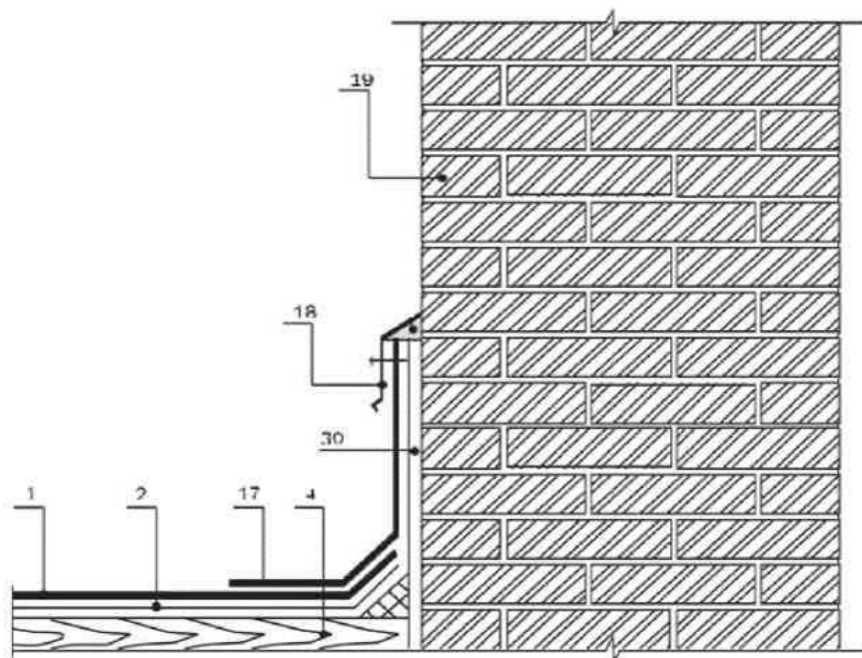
Устройство узлов примыкания кровли к дымовой кирпичной трубе с использованием покрытия «Euromast Color™»
